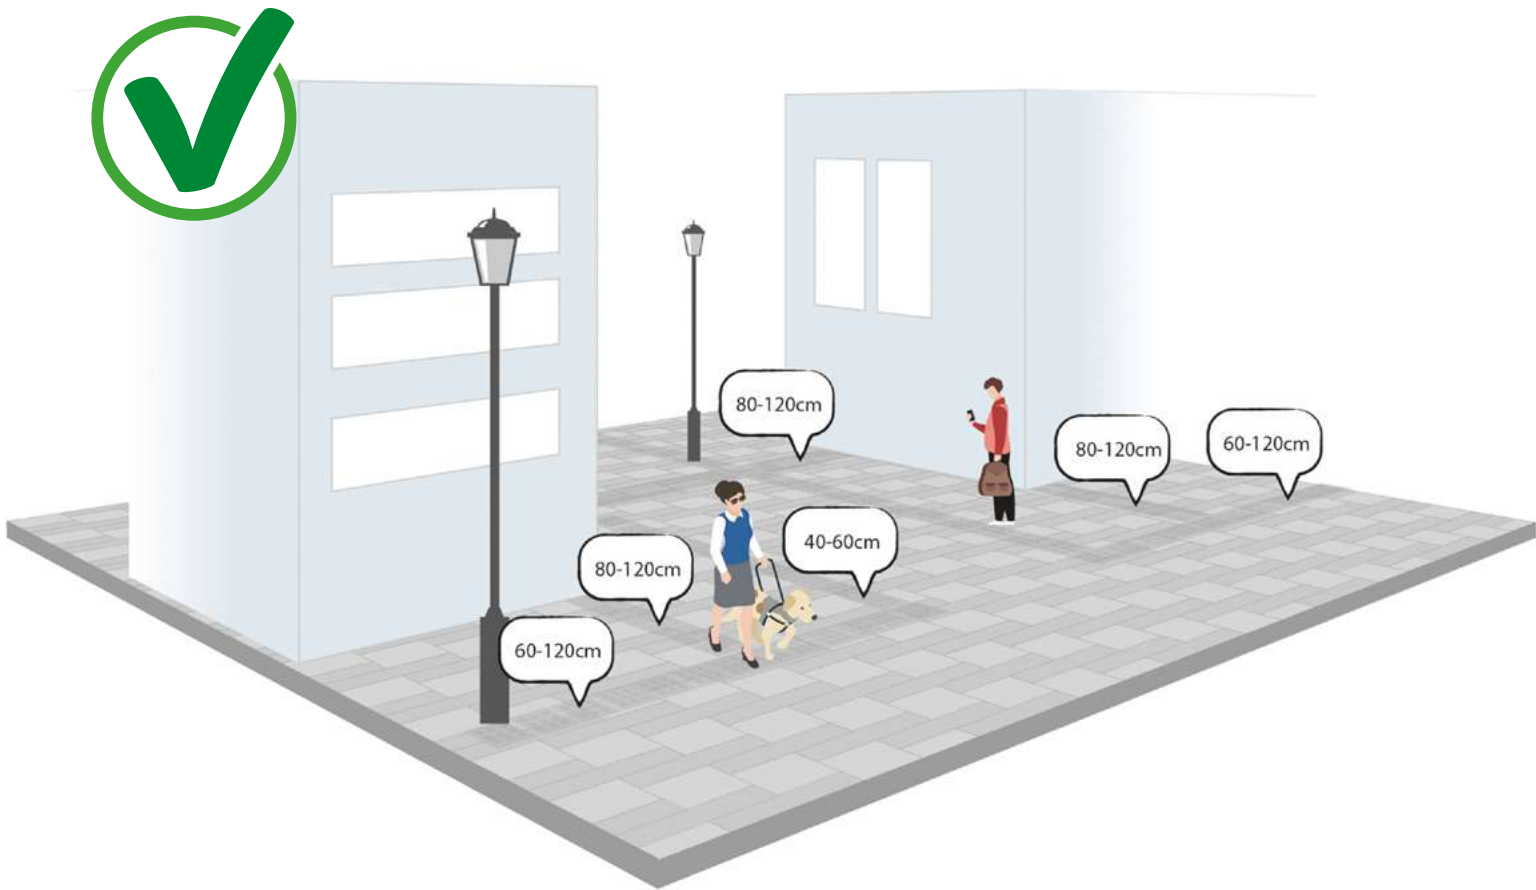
Anchura de los pavimentos tacto-visuales de advertencia y direccional.
